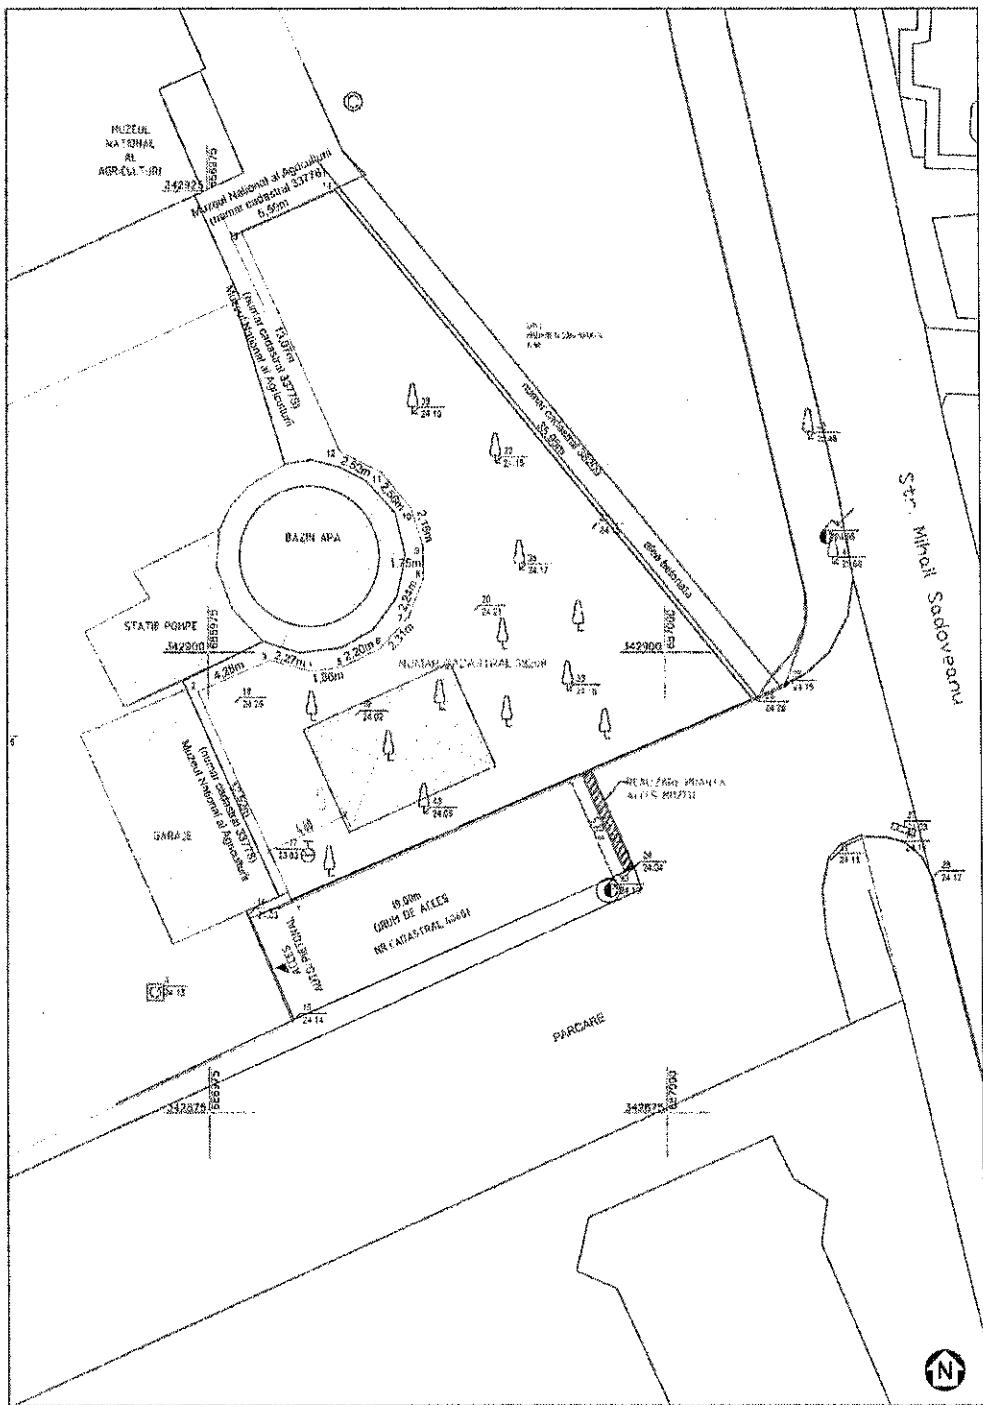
Plan de situatie – Amplasare Poarta de acces muzeu
